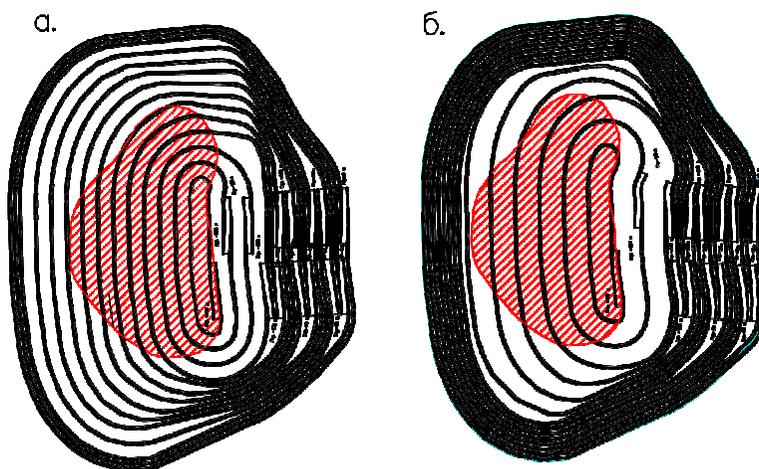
Сводные планы горных работ на момент вскрытия и подготовки гор. -210 м при работе с шириной рабочей площадки:
